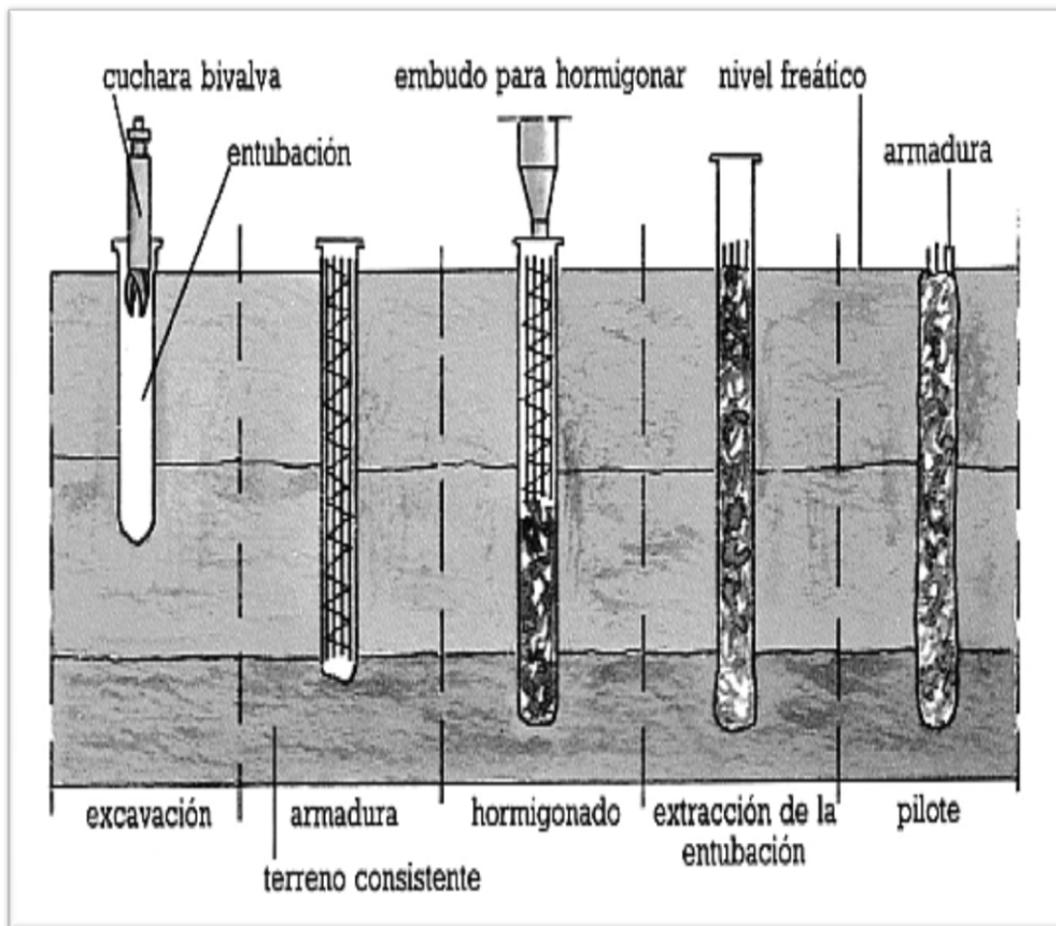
"Piloteado por excavación, entubación, extracción, armadura y colado"
